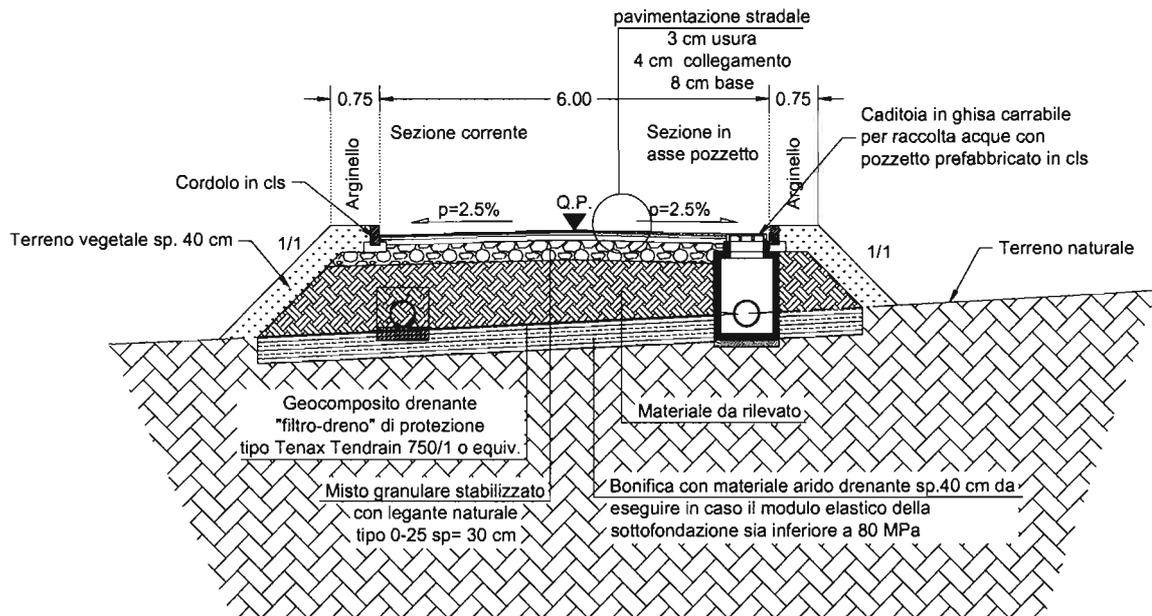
Sezione Tipo Strada Accesso Cantiere Forch
